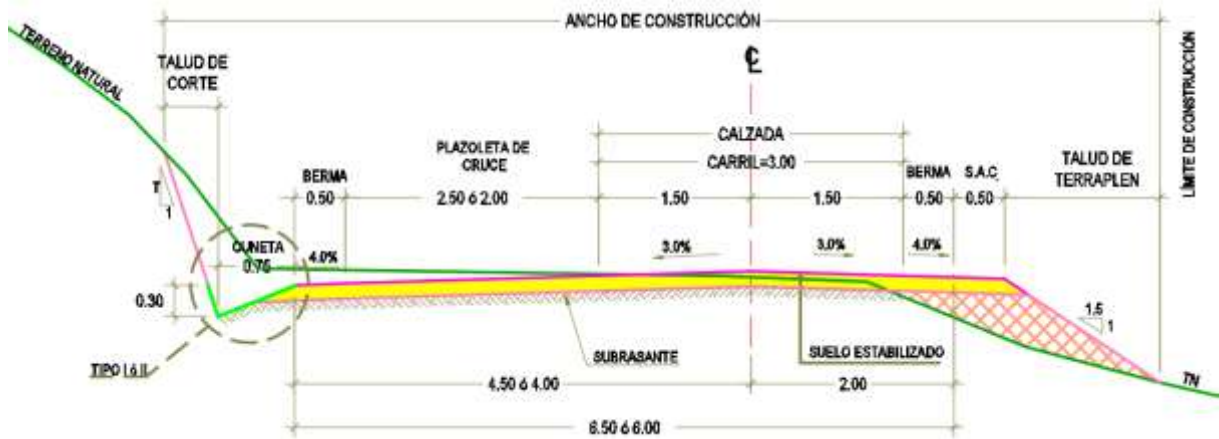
Sección típica con plazoleta de cruce lado izquierdo. Fuente: Plano de Secciones Típicas.
